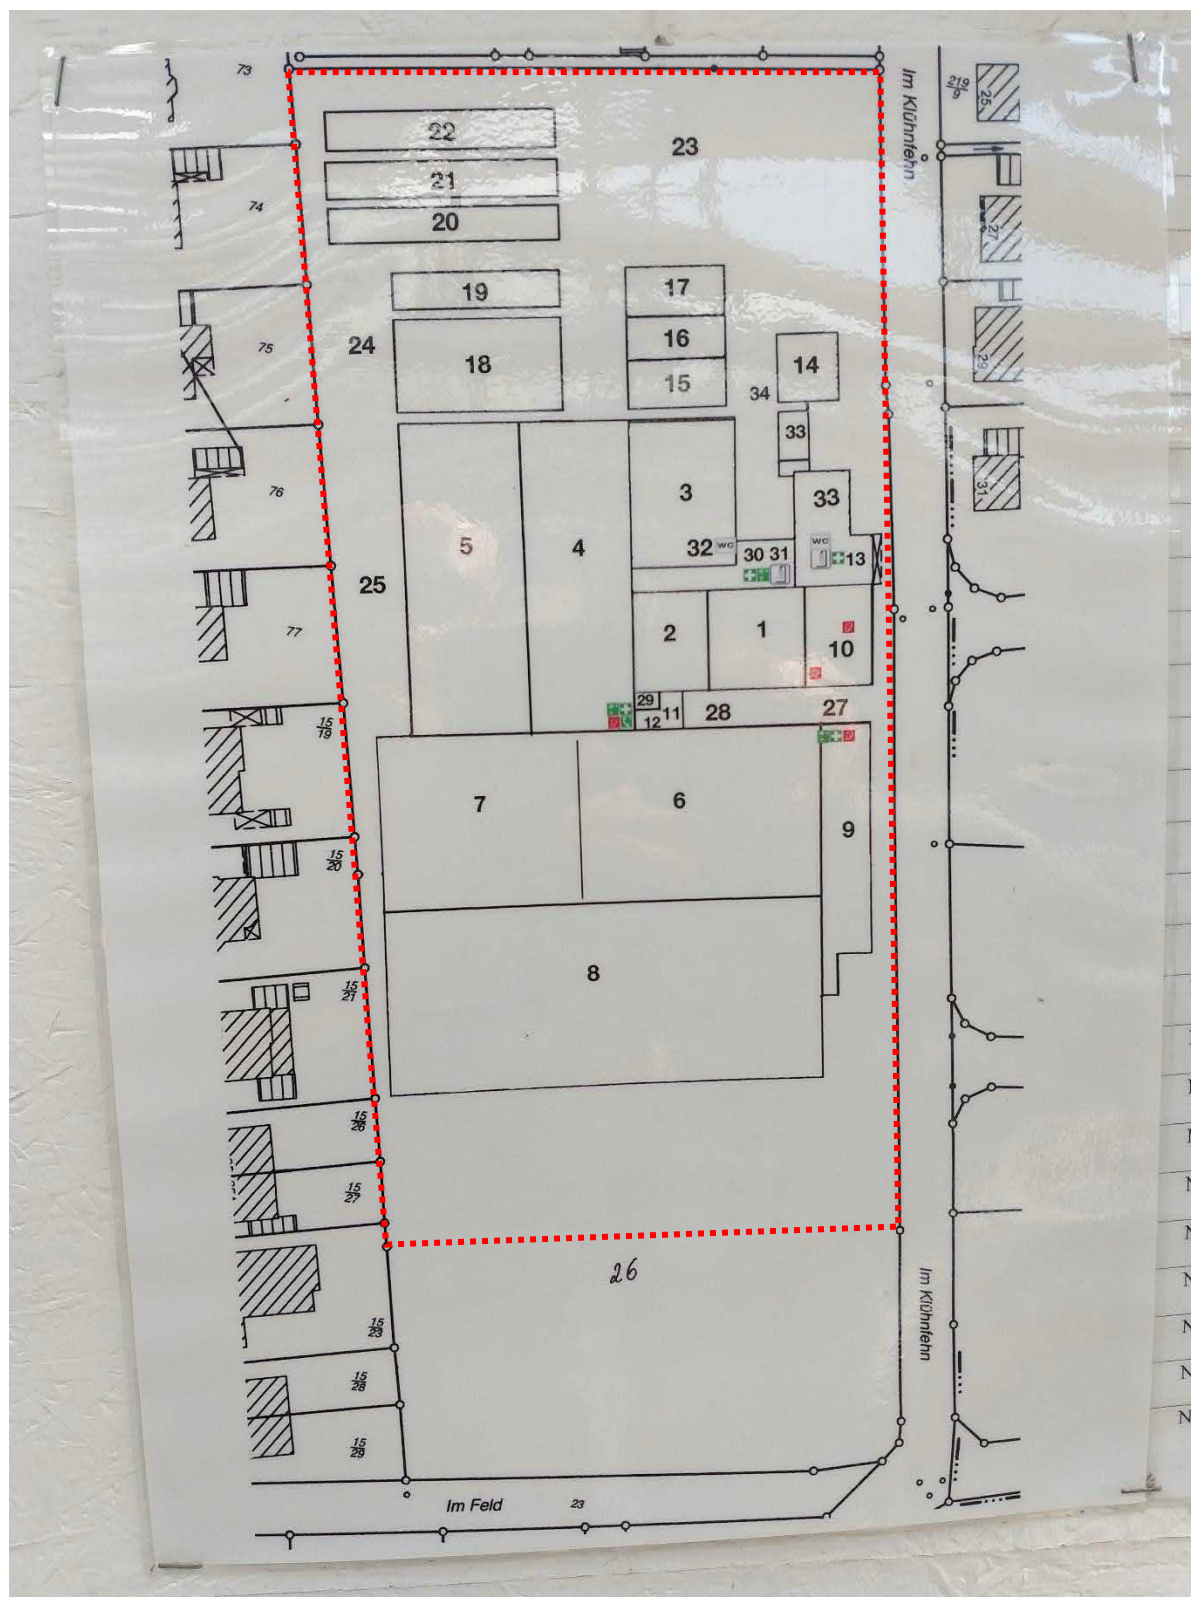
Betriebsfläche der Gärtnerei mit baulichen Anlagen; Bewertungsfläche gekennzeichnet
